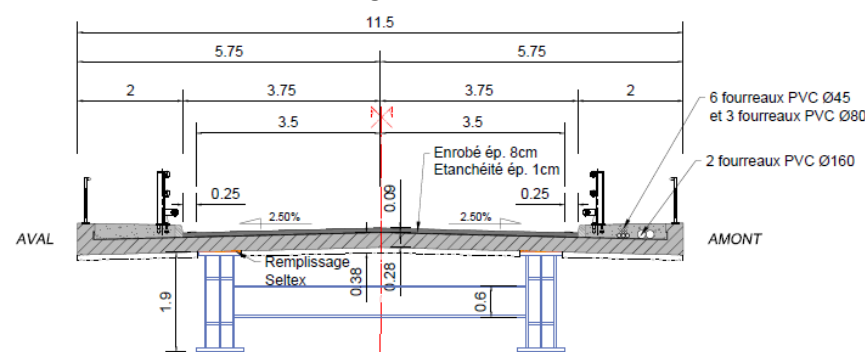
Coupe transversale du tablier du futur ouvrage d'art (source : APD - additif, Infratech)
